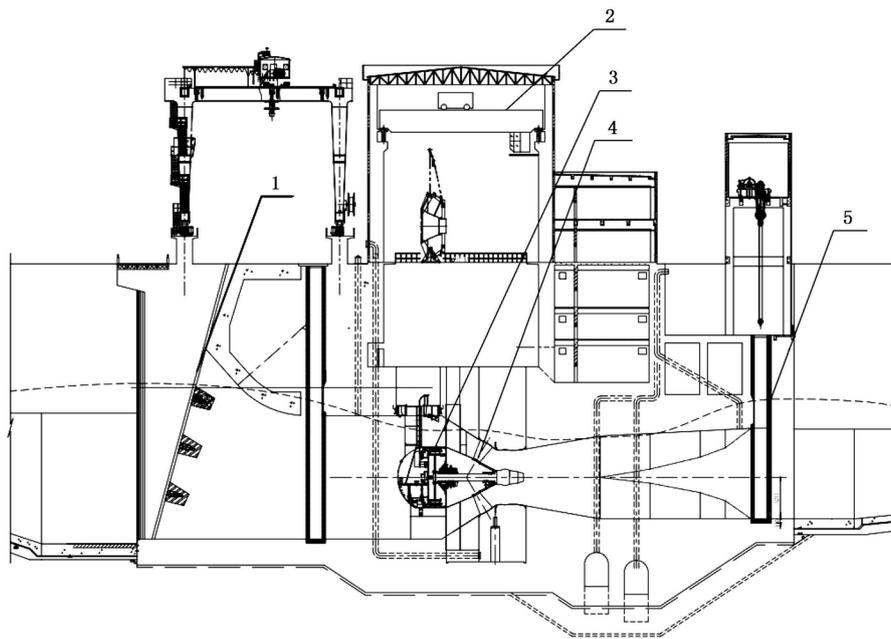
Plano de secção transversal da central eléctrica da unidade horizontal
